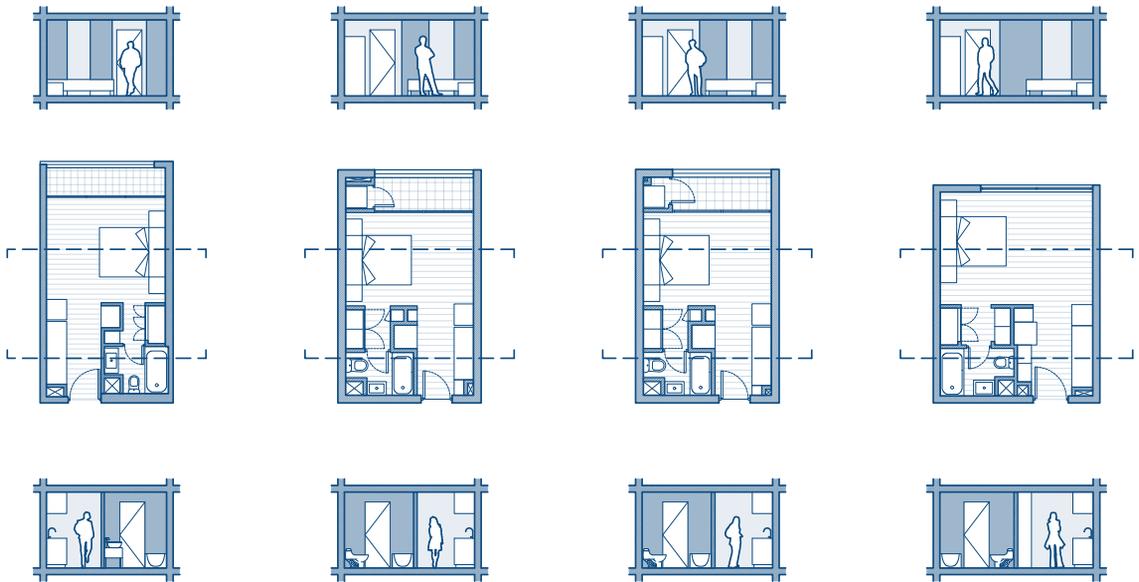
/ Plantas y secciones de departamentos XS en Santiago
